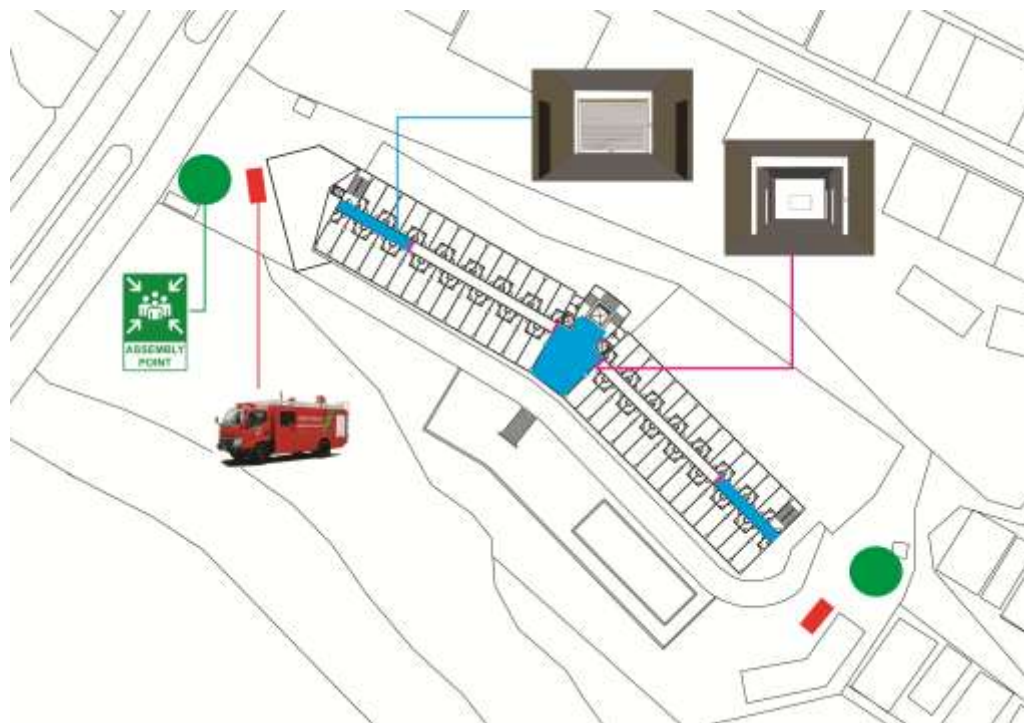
Rekomendasi Proteksi Kebakaran pada Layout
